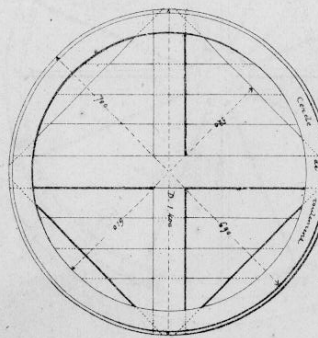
Plan du plateau de fondation, à 0,04 p.m.
